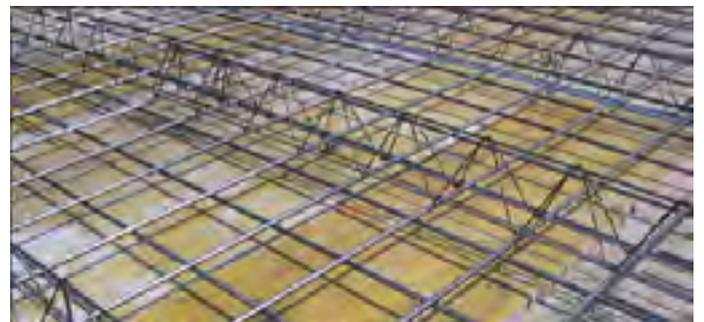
Detalle inferior del mecano de encofrado de losa in situ. Armado de losa in situ.
